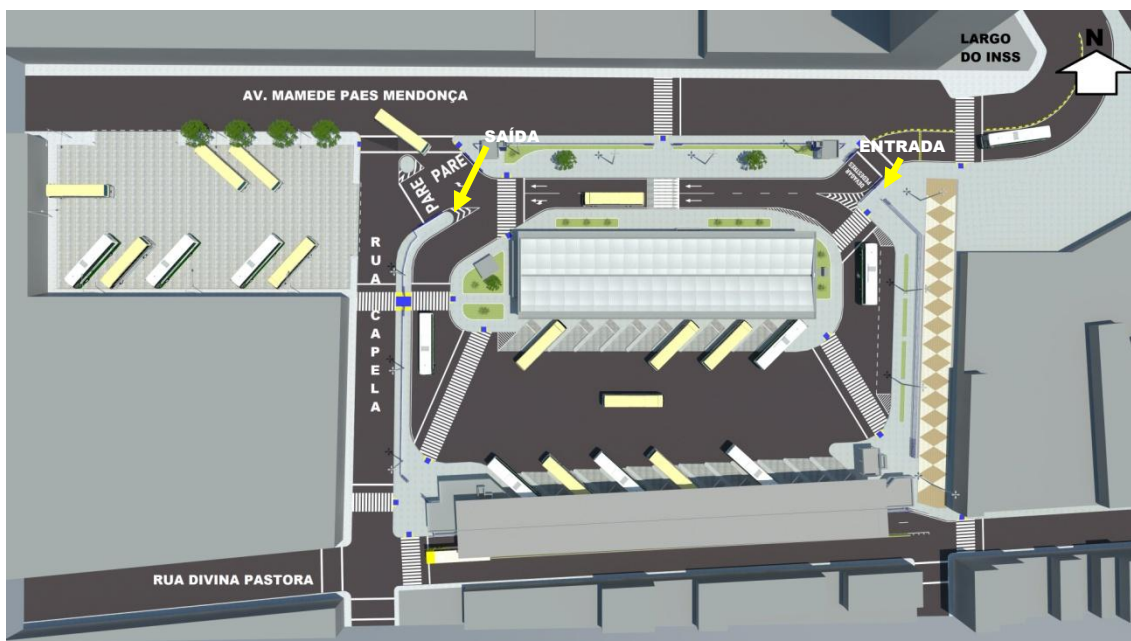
Implantação geral da Praça João XXIII. Projeto de Intervenção.
